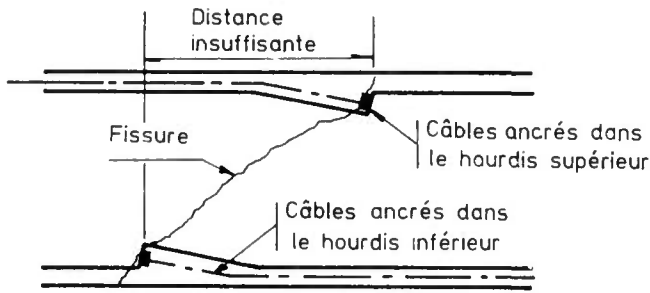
Jonction entre deux systèmes de fissuration d'entraînement et de diffusion.
